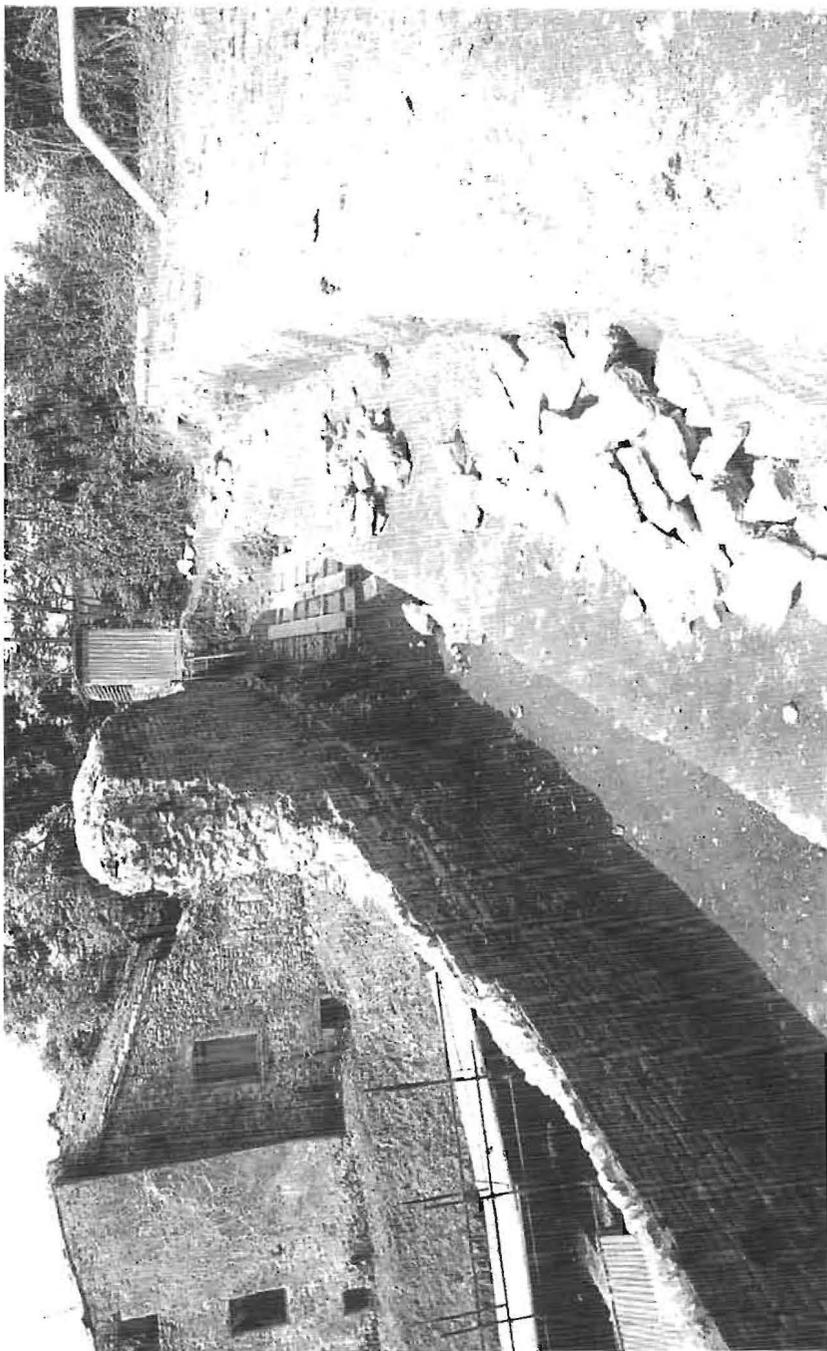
Alleggerimento della spinta del terreno dietro il muro perimetrale semiciccolare.
